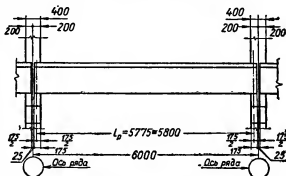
Определение расчетного пролета сборной подкрановой балки.
